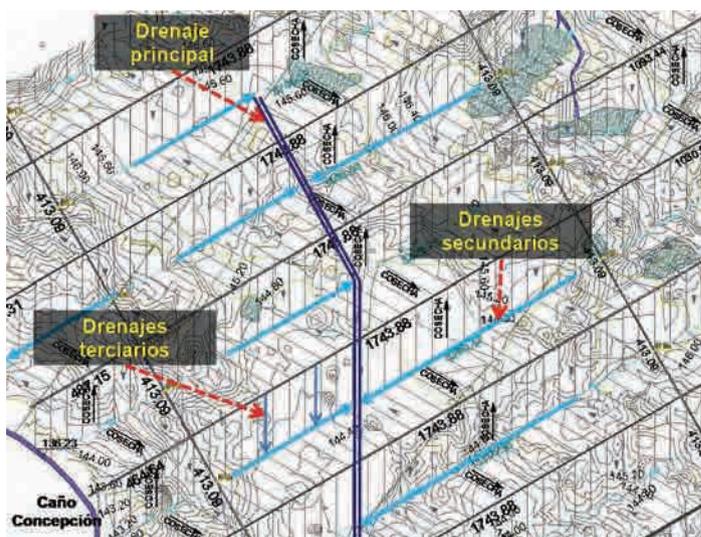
Plano de diseño de canales de drenaje en cultivo de palma.
